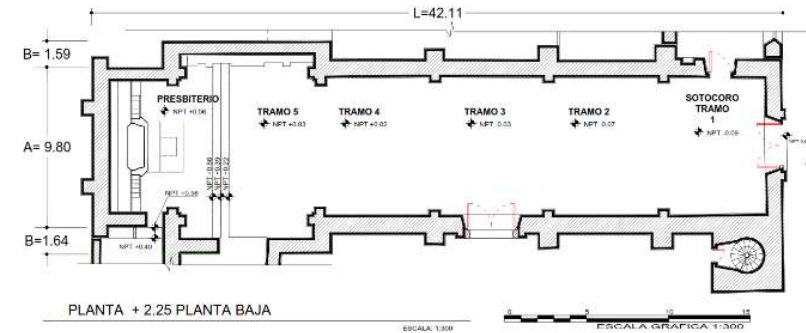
medidas para evaluar la configuración planimétrica, tomando como base el levantamiento arquitectónico. Autor: SLF
